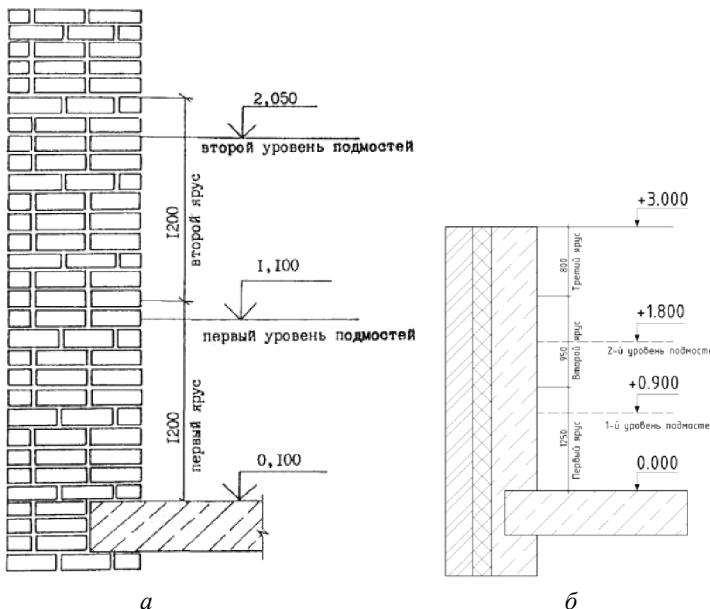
Деление стены на ярусы: *a* – пример сплошной кладки стен; *б* – пример условной схемы трехслойной кладки наружных стен
